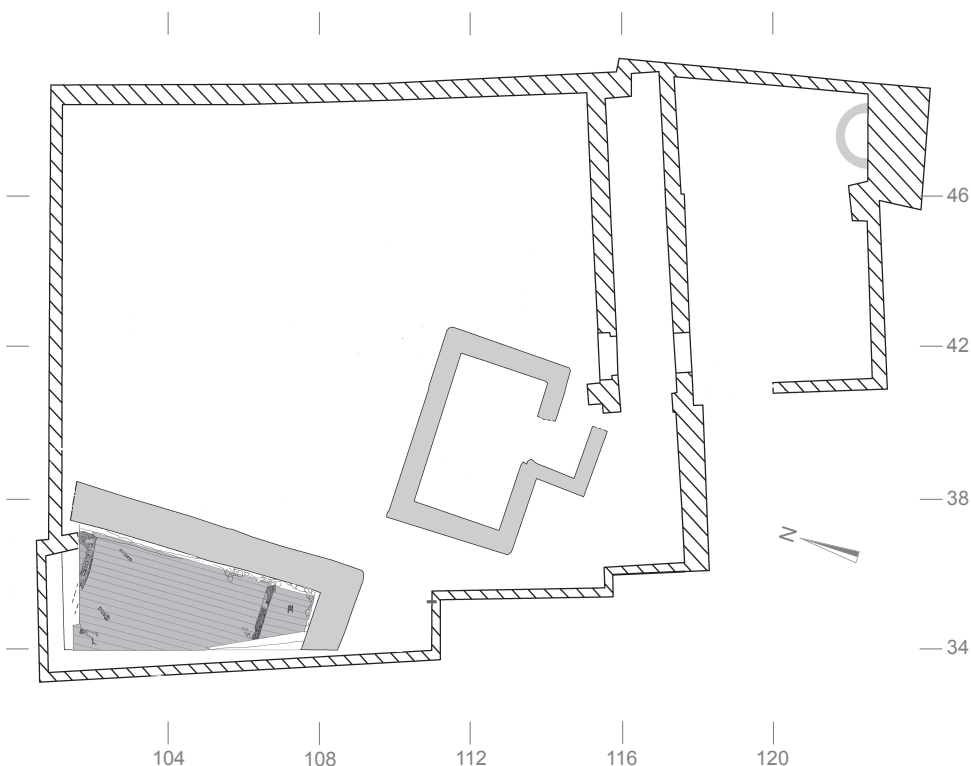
Plan der Steinbauphase mit Steinbau (inkl. rekonstruierter Holzboden), Steinkeller und Sodbrunnen. M. 1:200.
